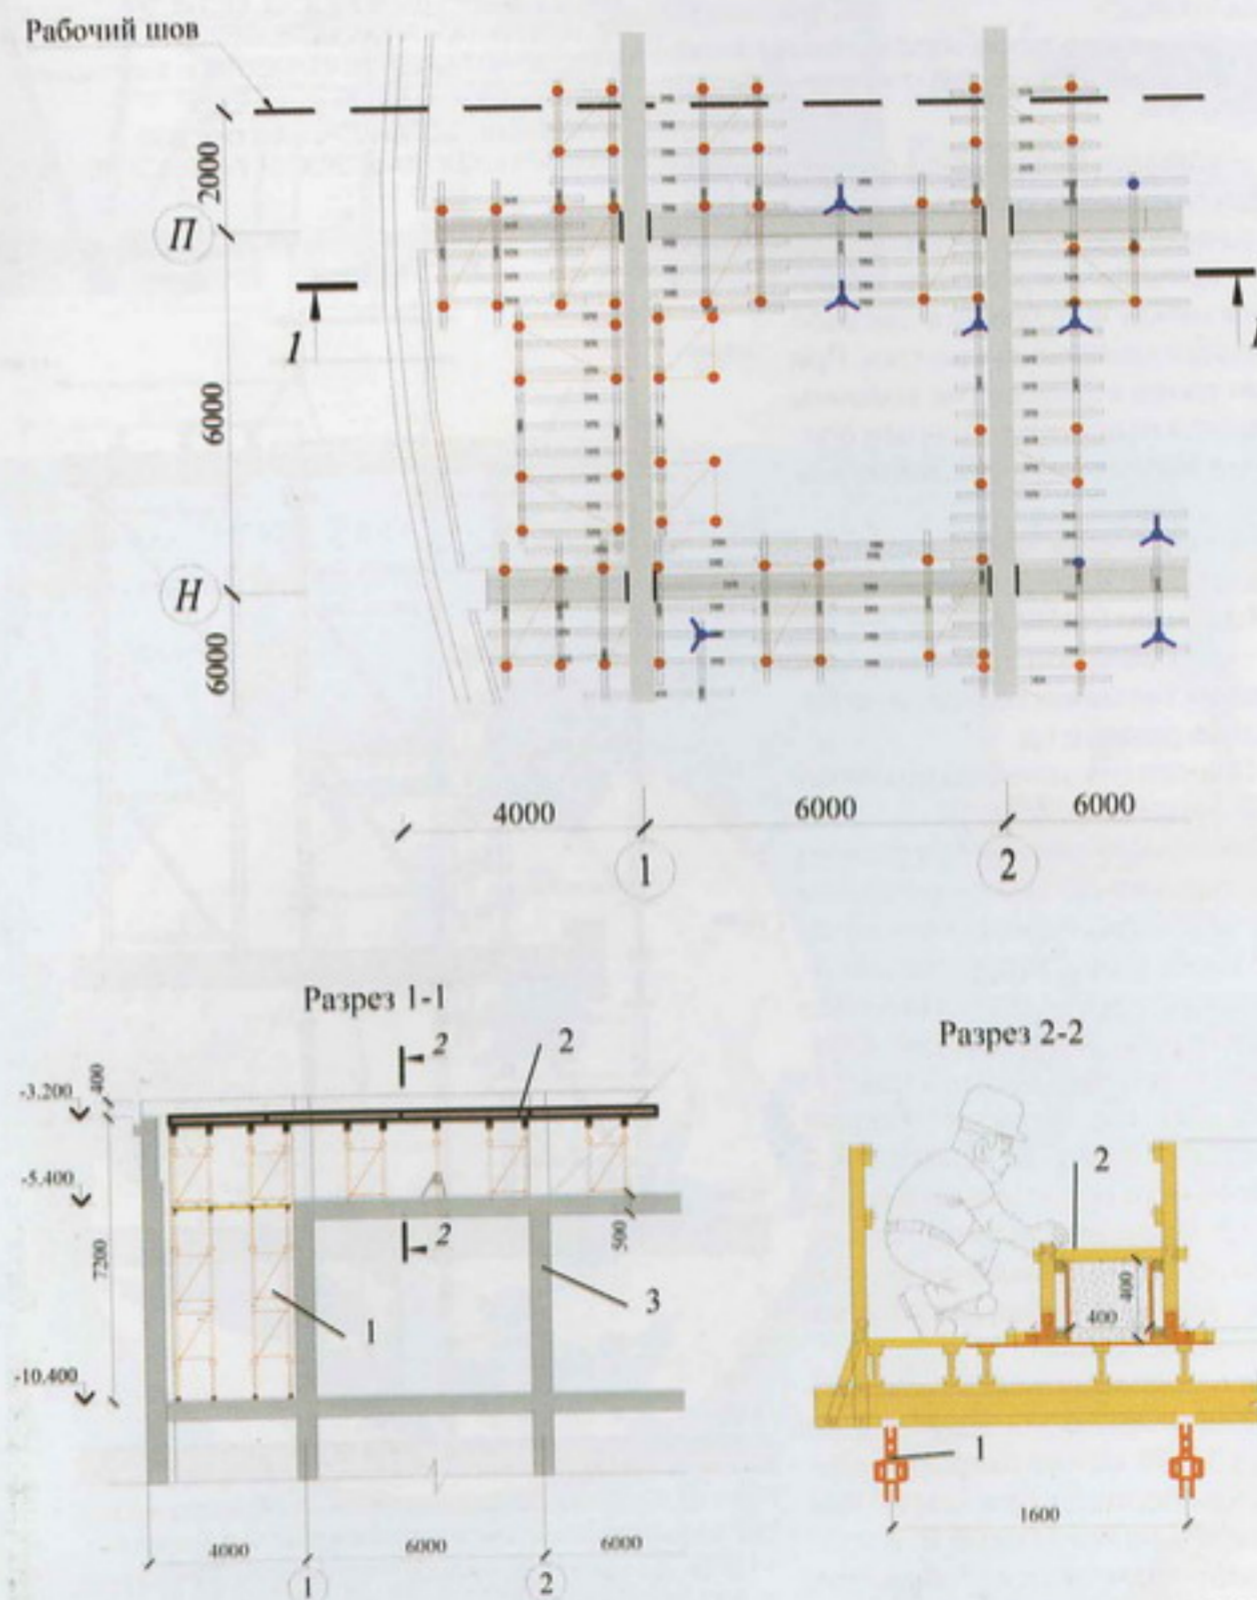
Схема опалубки перекрестных монолитных балок на отм. -3,200: 1 — опорная система из башен; 2 — опалубка монолитных балок; 3 — бетонные конструкции
